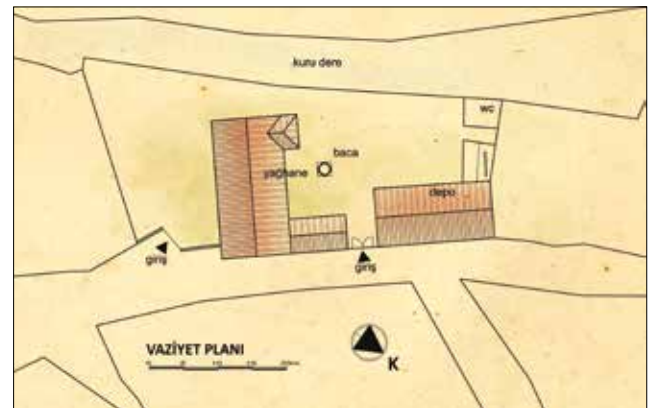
Ahmetçe Köyü'nde bulunan zeytinyağı fabrikası vaziyet planı şeması (Ayvacık) / The site plan of Olive oil factory in Ahmetçe Village
